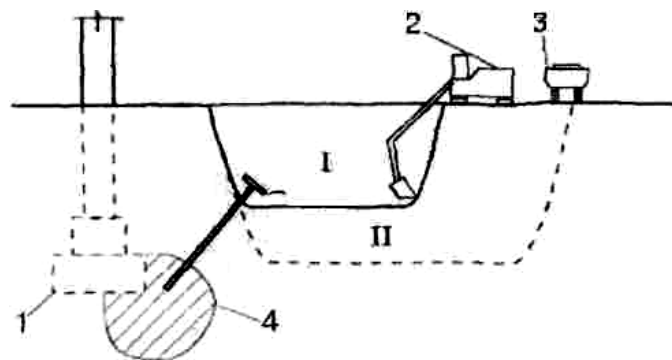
Схема розробки ґрунту глибоких вишок із закріпленням стінок: 1 – існуючий фундамент; 2 – екскаватор; 3 – автосамоскид; 4 – зона закріплюваного ґрунту; I, II – яруси розробки ґрунту
